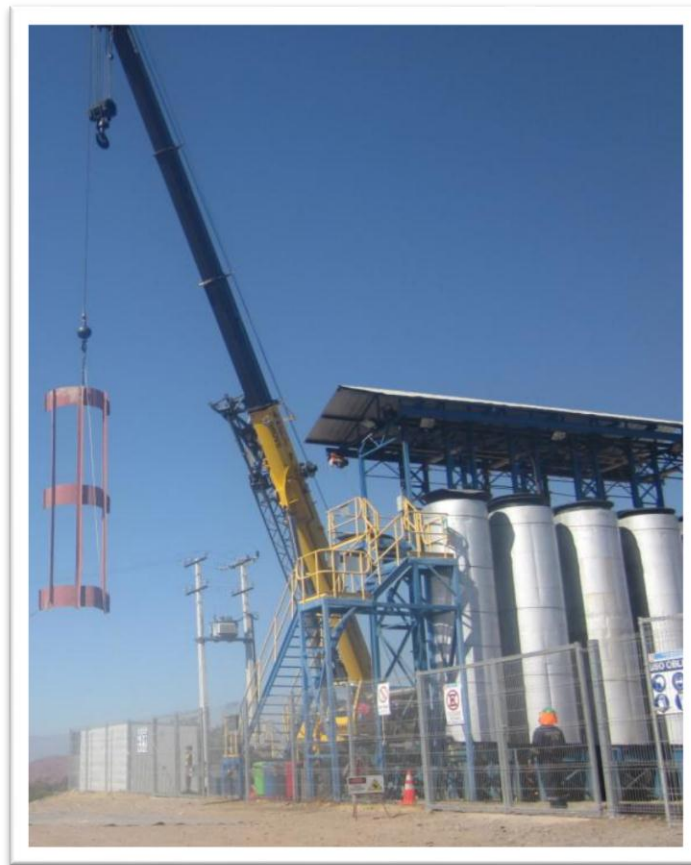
Izaje de Monturín, previo a retiro de columnas.
